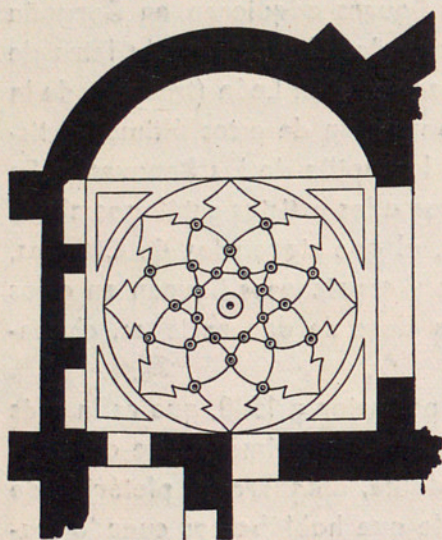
PLANTA DE LA CAPILLA DE LOS BENAVENTE.
